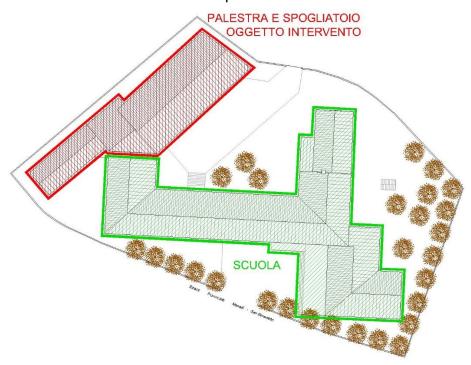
Planimetria del Plesso Scolastico ed individuazione delle unità strutturali.
